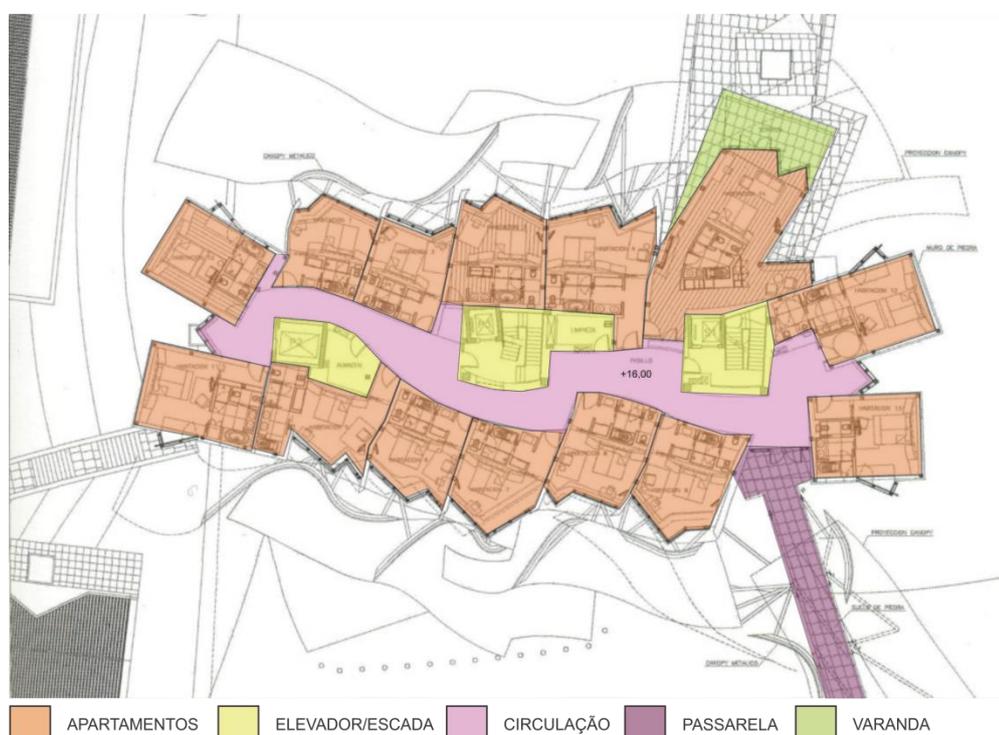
Planta baixa, Ambientes, 1º pavimento. Adaptada pelo autor.
